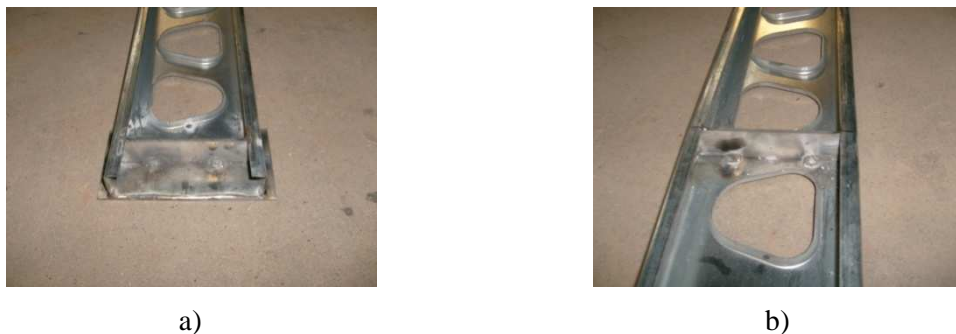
Chapas transversais: a) na zona dos apoios e b) sob as cargas pontuais.
